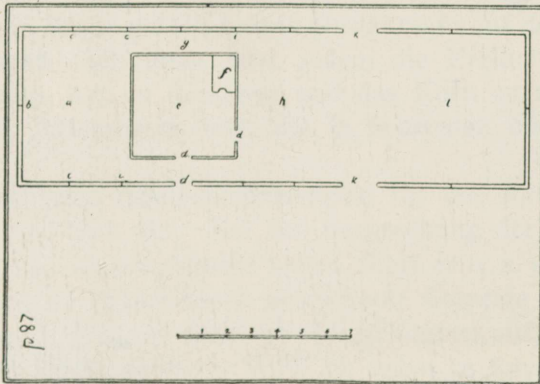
Grundriss eines Dörrhauses. a „Kurzstroh“-Raum. b und c Wände. d Türen. e Dörr-Raum. f Ofen. g Spreuhaus. h Dreschraum. i Verbindungsbalken. k Tore. L Lager-Raum für ungedroschenes Getreide.
